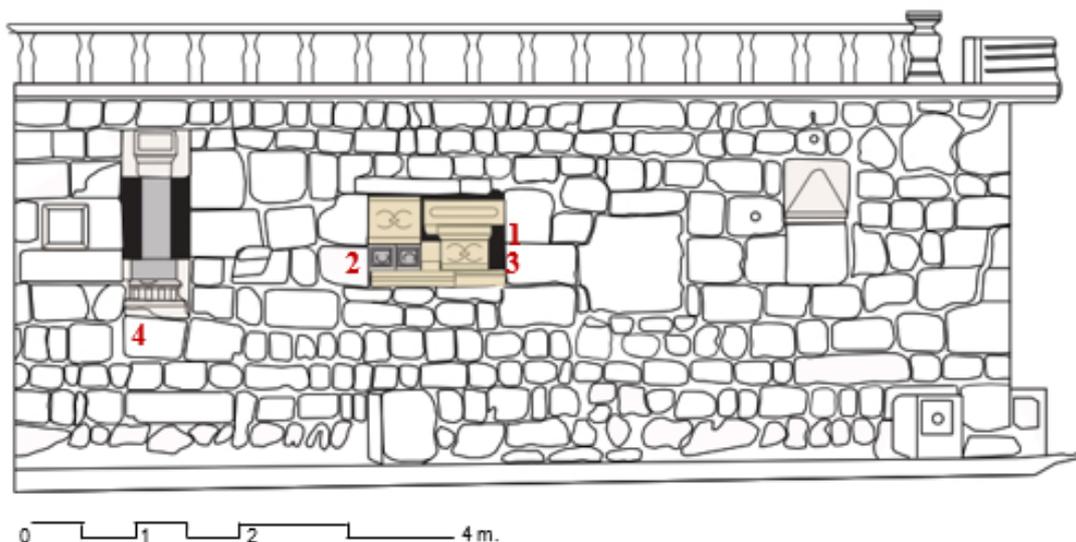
Plano de alzado portada lateral izquierdo (muestra 1, 2, 3 y 4)
